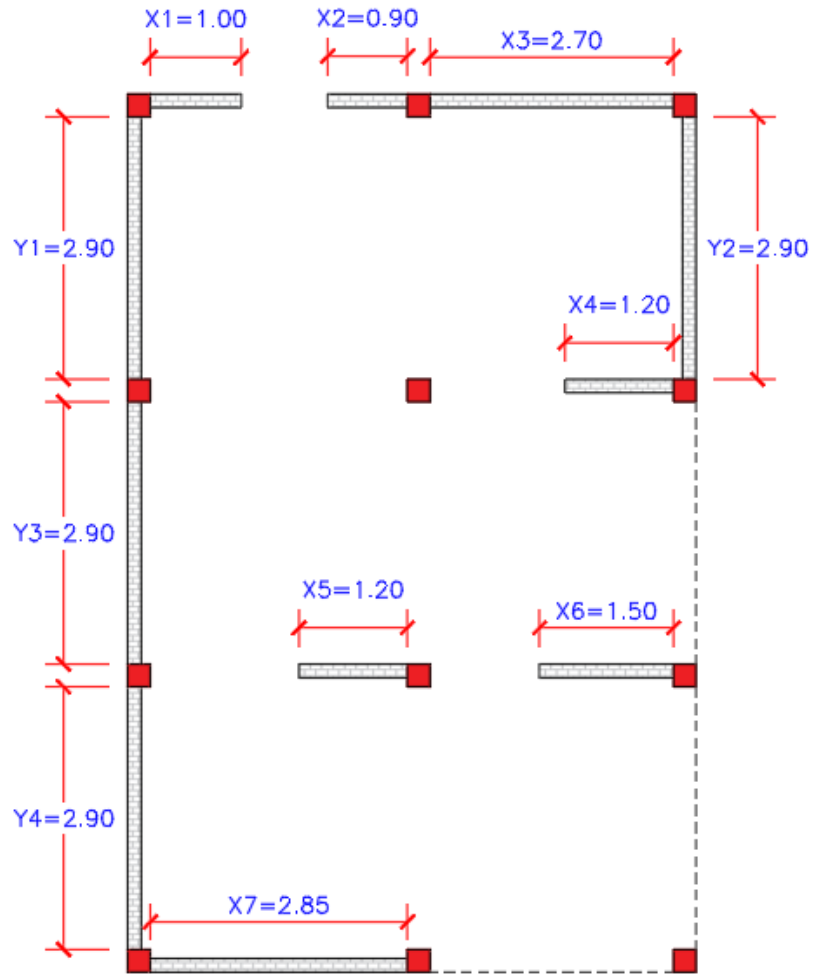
Muros portantes de Vivienda 14, vista de planta.
